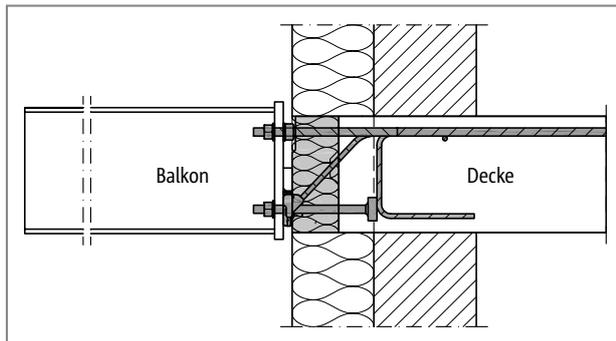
Schöck Isokorb® T Typ SK: Dämmkörper schließt mit Hilfe des Deckenvorsprungs außen bündig mit der Dämmung der Wand ab, dabei sind die seitlichen Randabstände zu beachten
